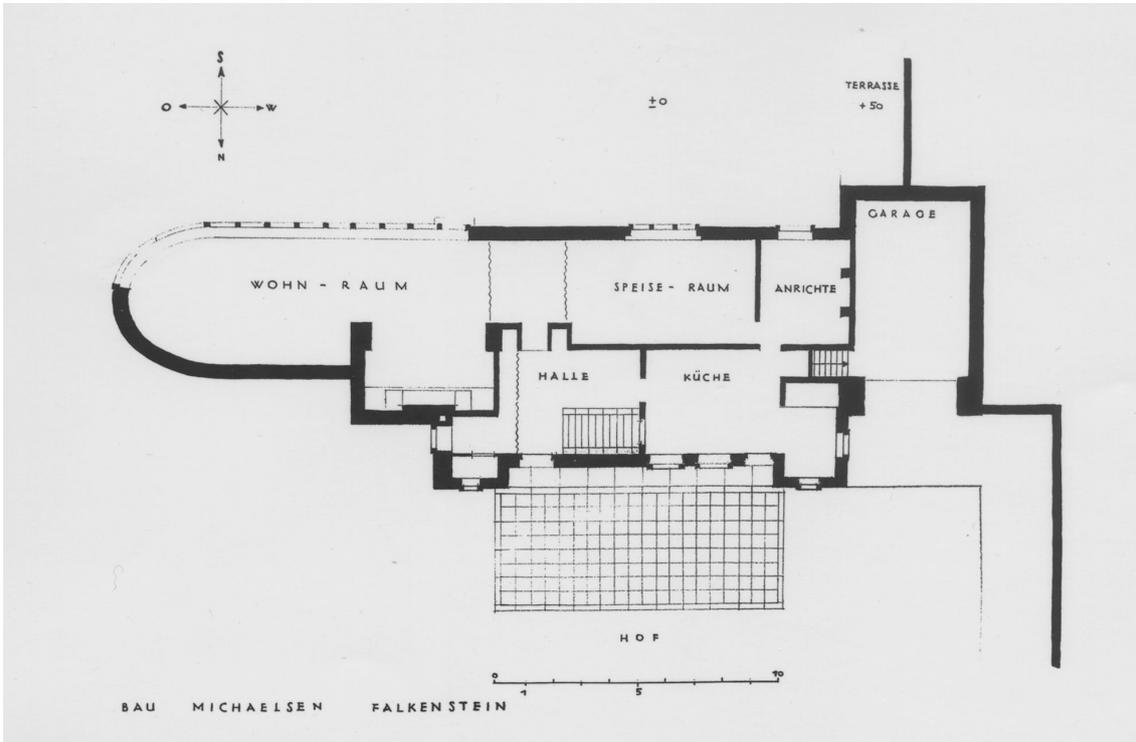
Grundriss Erdgeschoss, Publikationsplan, ohne Datum (1924)
